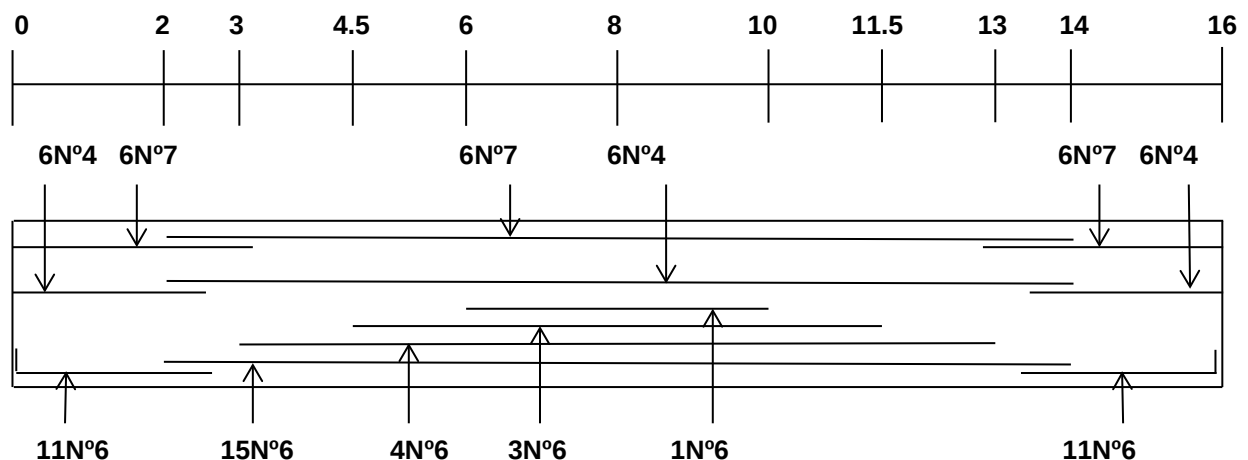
Detalle Constructivo de la armadura de la viga, sección longitudinal
